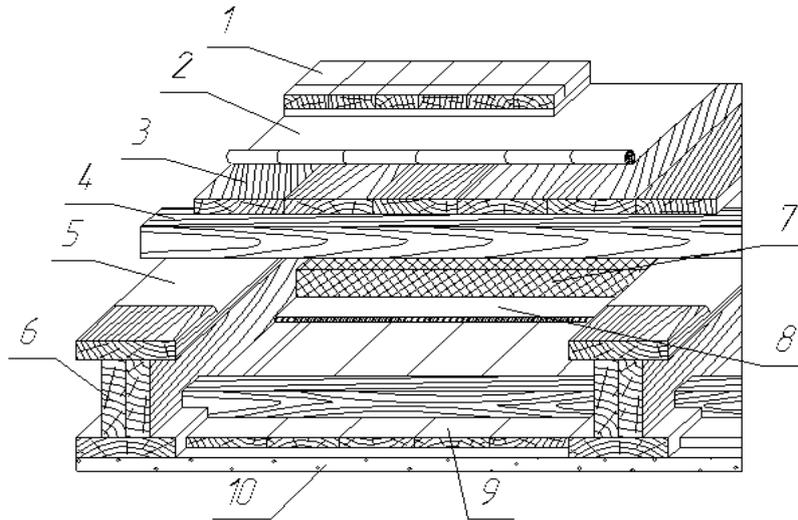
Общий вид межэтажного перекрытия по клееным балкам:
